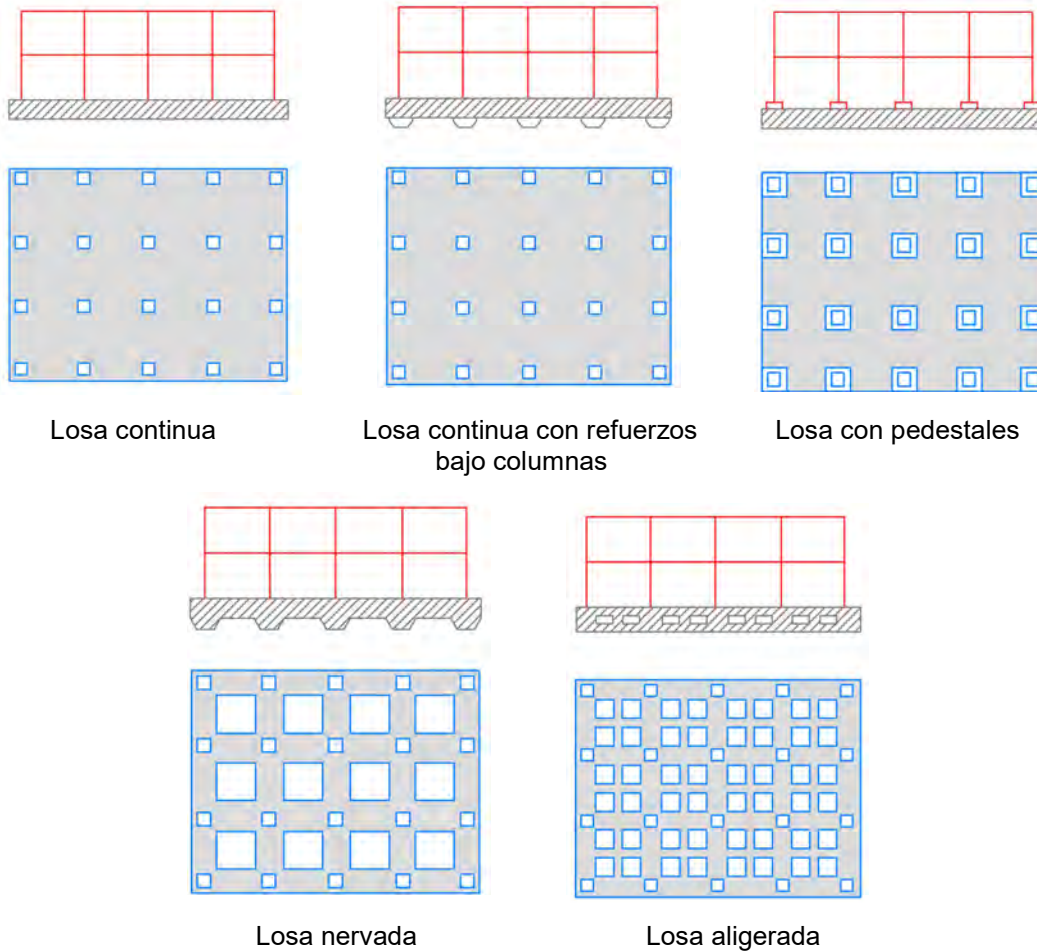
TIPOS DE LOSAS DE CIMENTACIÓN
